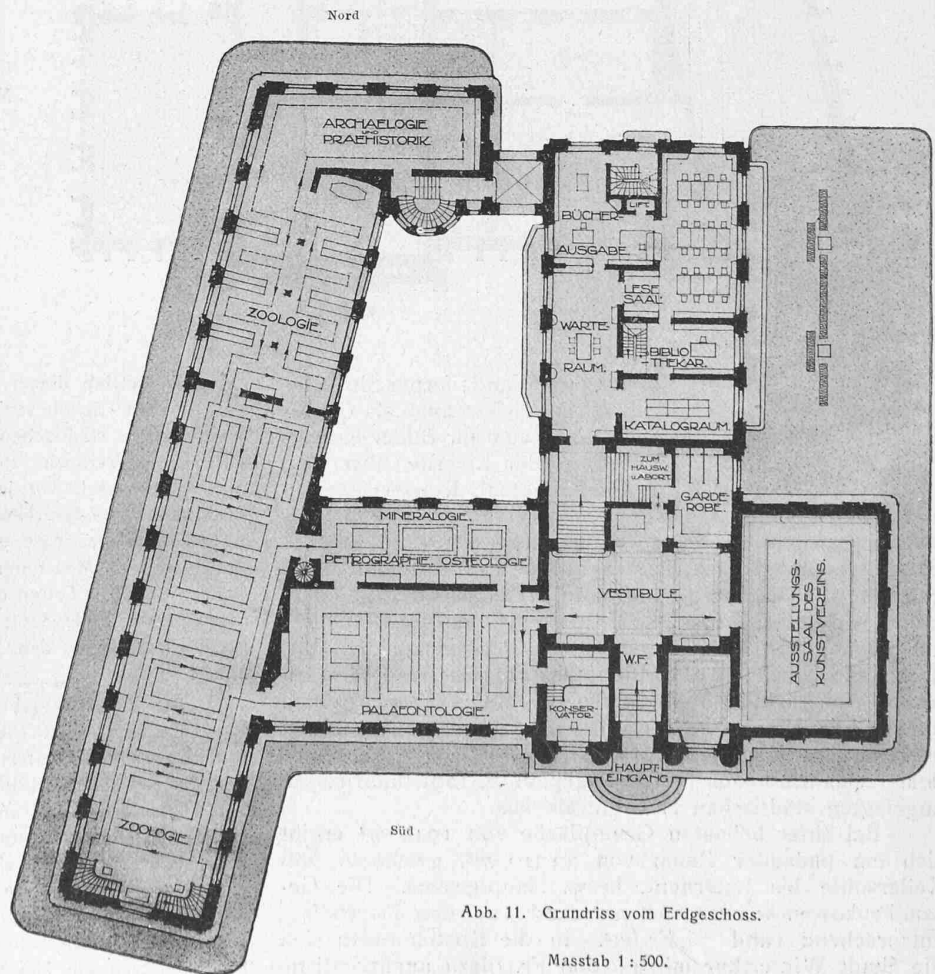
Grundriss vom Erdgeschoss.
